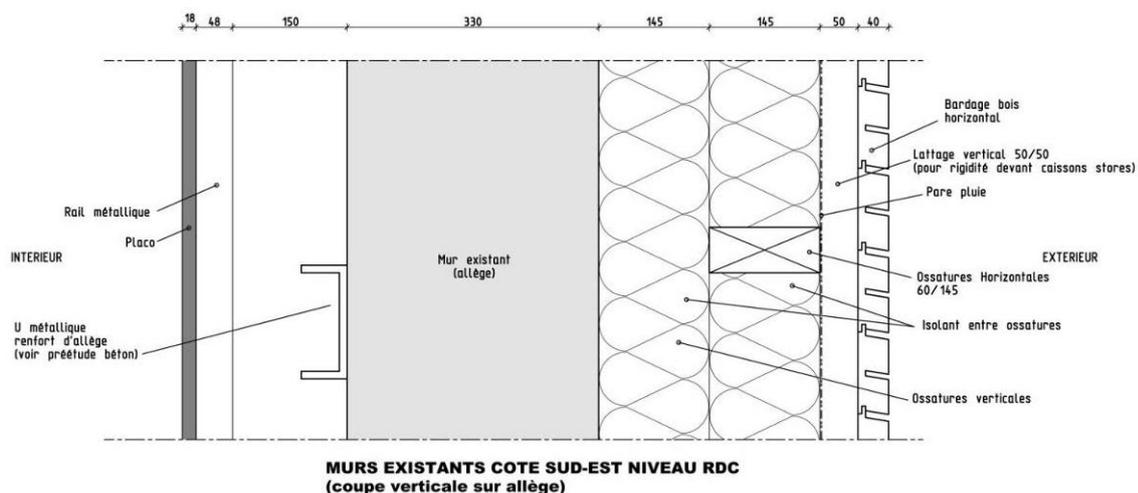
Détail sur le mur existant isolé par l'extérieur.
